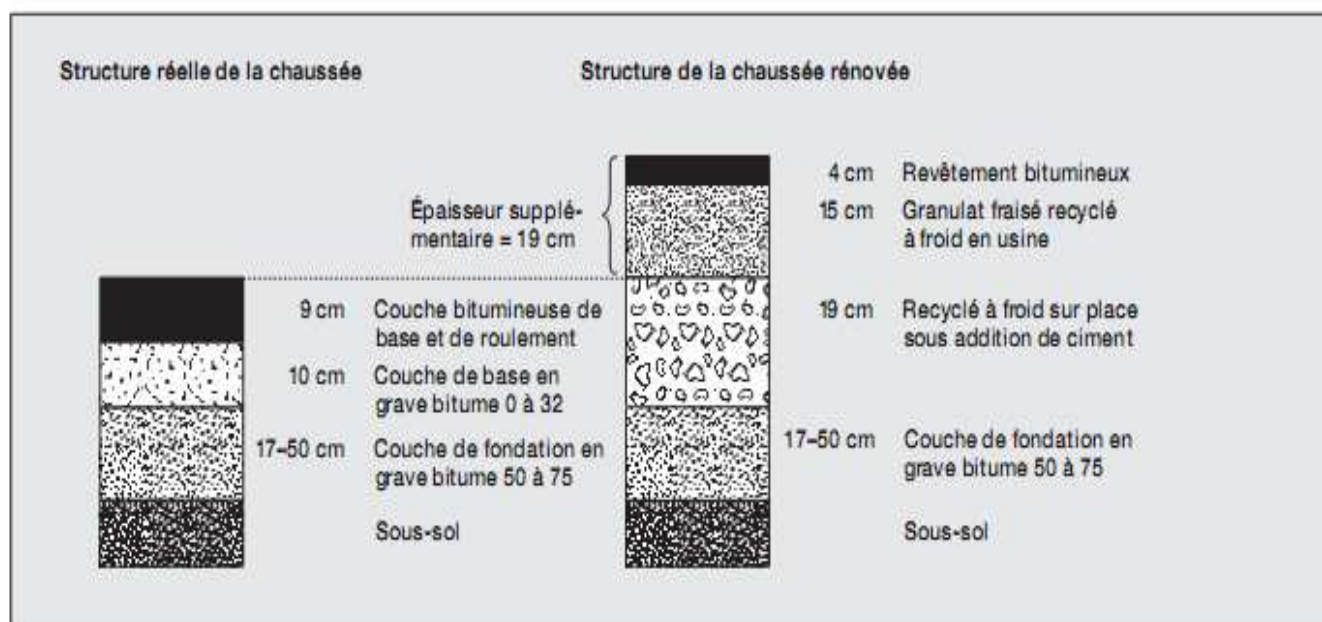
8: Structure réelle de la chaussée et structure de la chaussée rénovée.
